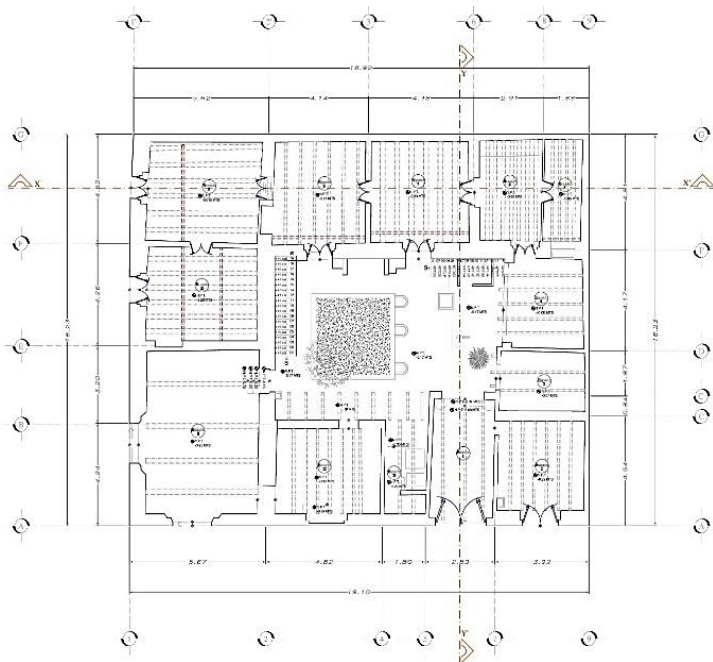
Plano de distribución de vigas. Planta Baja Fuente propia: Arq. Jacqueline Sánchez con fecha Enero 2016
